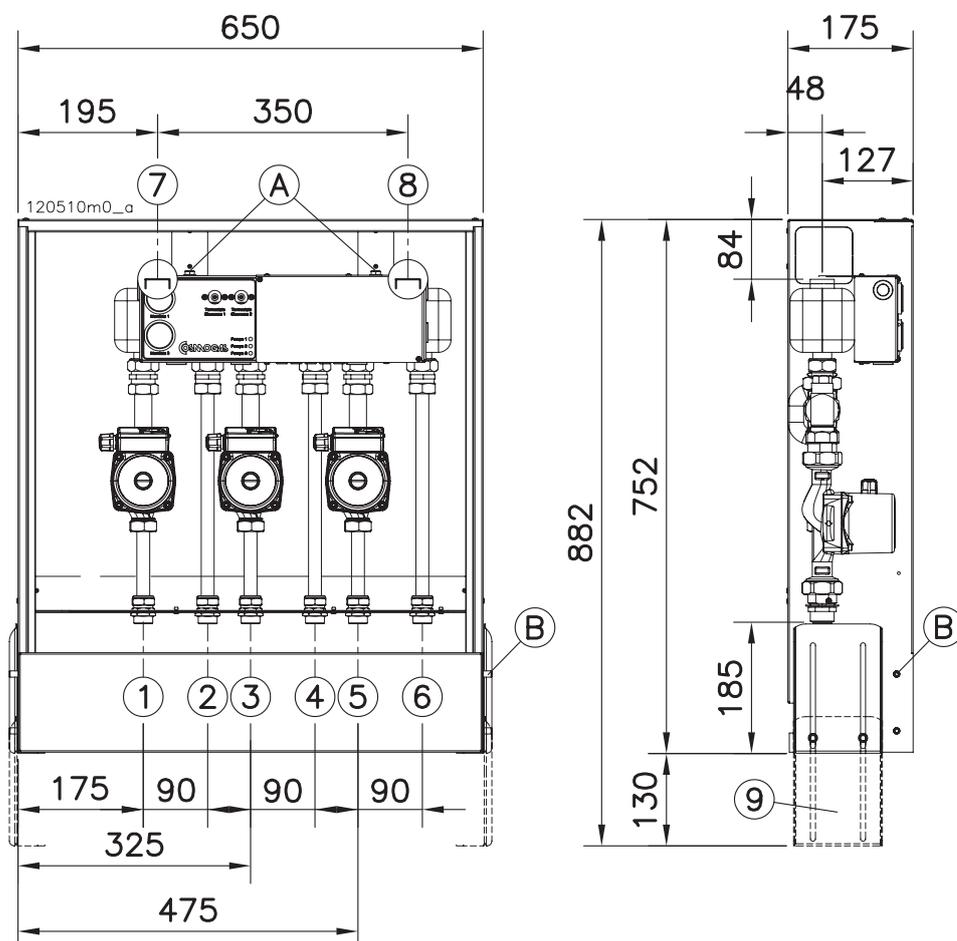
Dimensioni e interassi attacchi modelli O e Q
